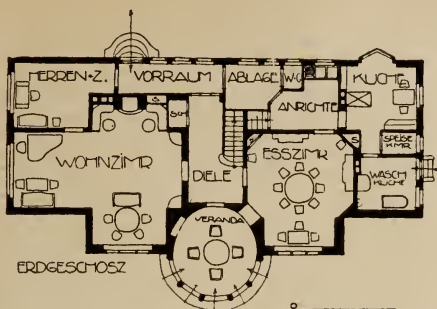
74. Eingeschossiges Haus (Künstlerhaus) mit völlig ausgebautem Dachgeschoß
